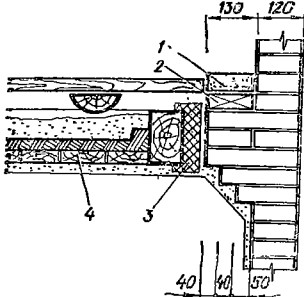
Устройство разделки в междуэтажном перекрытии:
